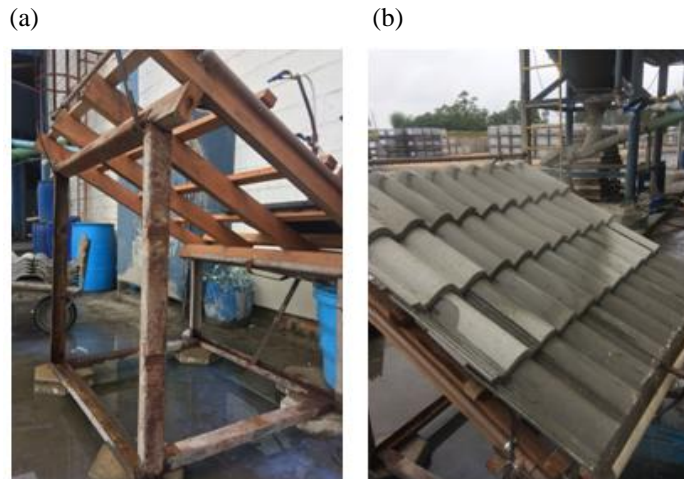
Ensaio de estanqueidade do sistema de cobertura: (a) estrutura semelhante à estrutura de um sistema de cobertura, (b) telhas posicionadas e recebendo água
